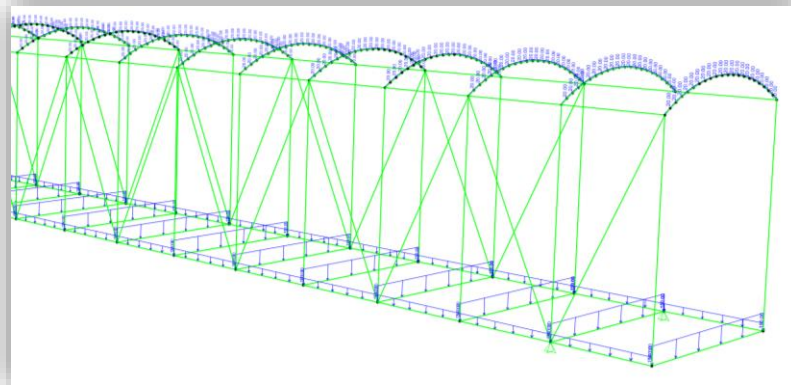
Vista en Sección Longitudinal de la estructura con carga muerta Permanente (DEAD).
